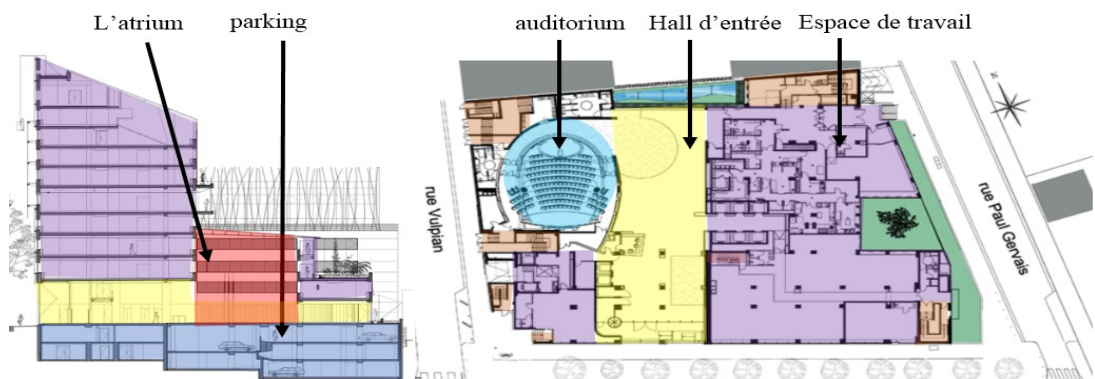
Coupe et plan du rez-de-chaussée. Source : <https://www.metalocus.es/en/news/headquarters-newspaper-le-monde>
